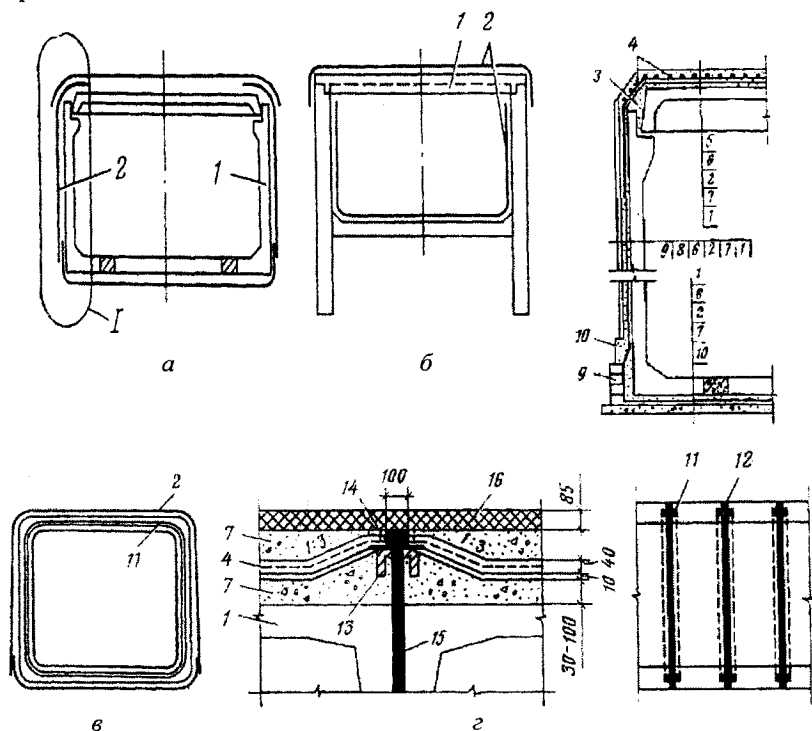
Гідроізоляція підземних споруд, що будуються котлованим (а, в, г) і траншейним (б) способами: 1 – залізобетонний блок; 2 – обклеювальна ізоляція; 3 – гальтель; 4 – сталевая сітка; 5 – бетонне покриття; 6 – захисний шар; 7 – стяжка, що вирівнює; 8 – бітумна обмазка; 9 – захисна стінка; 10 – бетонна підготовка; 11 – паз; 12 – ущільнювач; 13 – дерев'яні пробки; 14 – компенсатор з латуні; 15 – канат; 16 – дорожнє покриття
